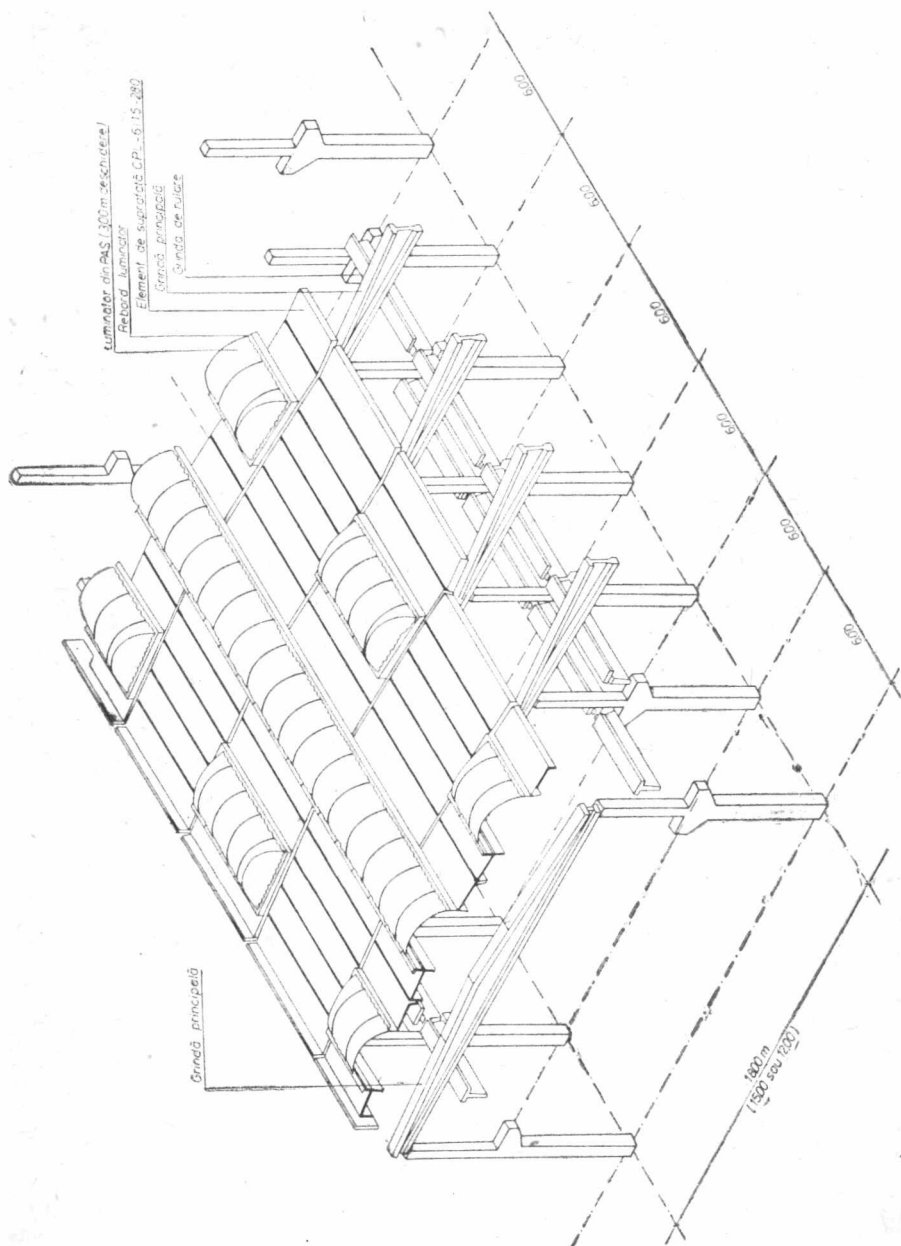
Elemente prefabricate de suprafață din beton armat :
